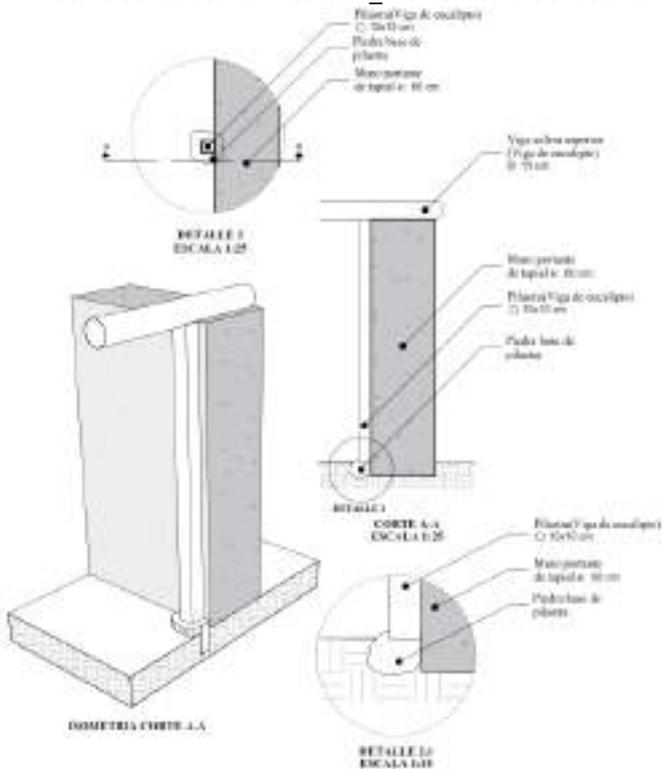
Corte A_A, isometría y detalles constructivos del corte.
